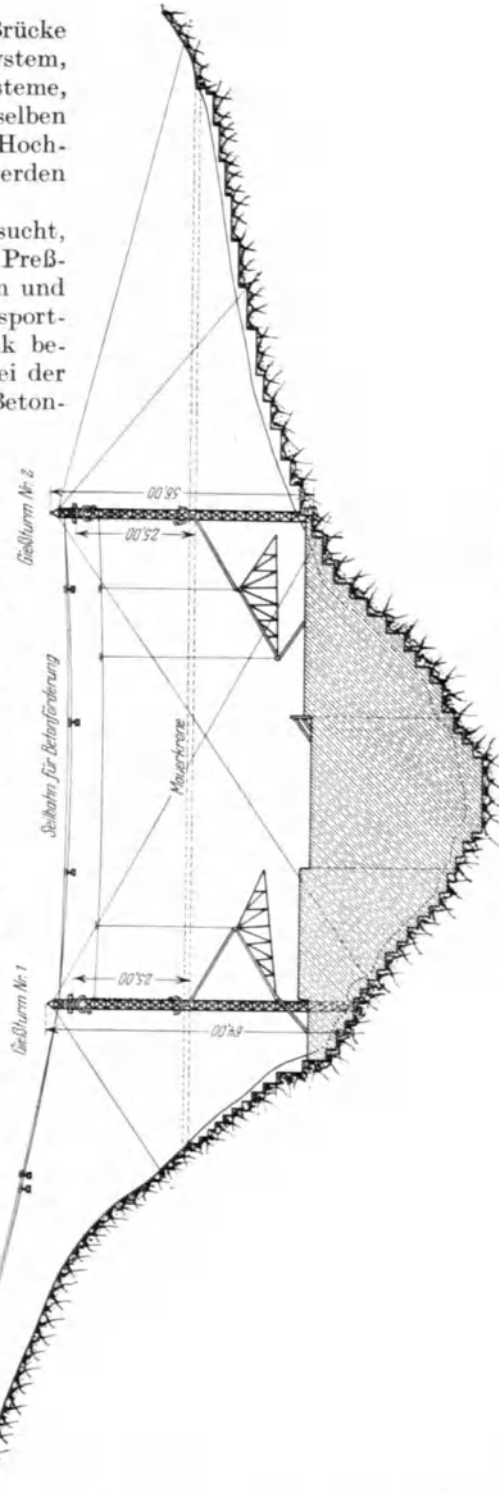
Entwurf einer Betonierungsanlage mit Seilbahn.
